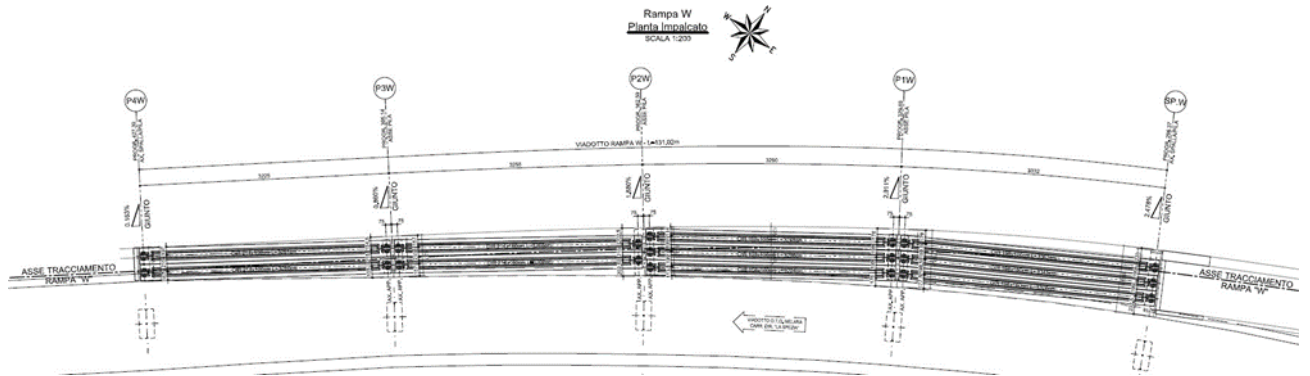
Planimetria Rampa W svincolo Melara
